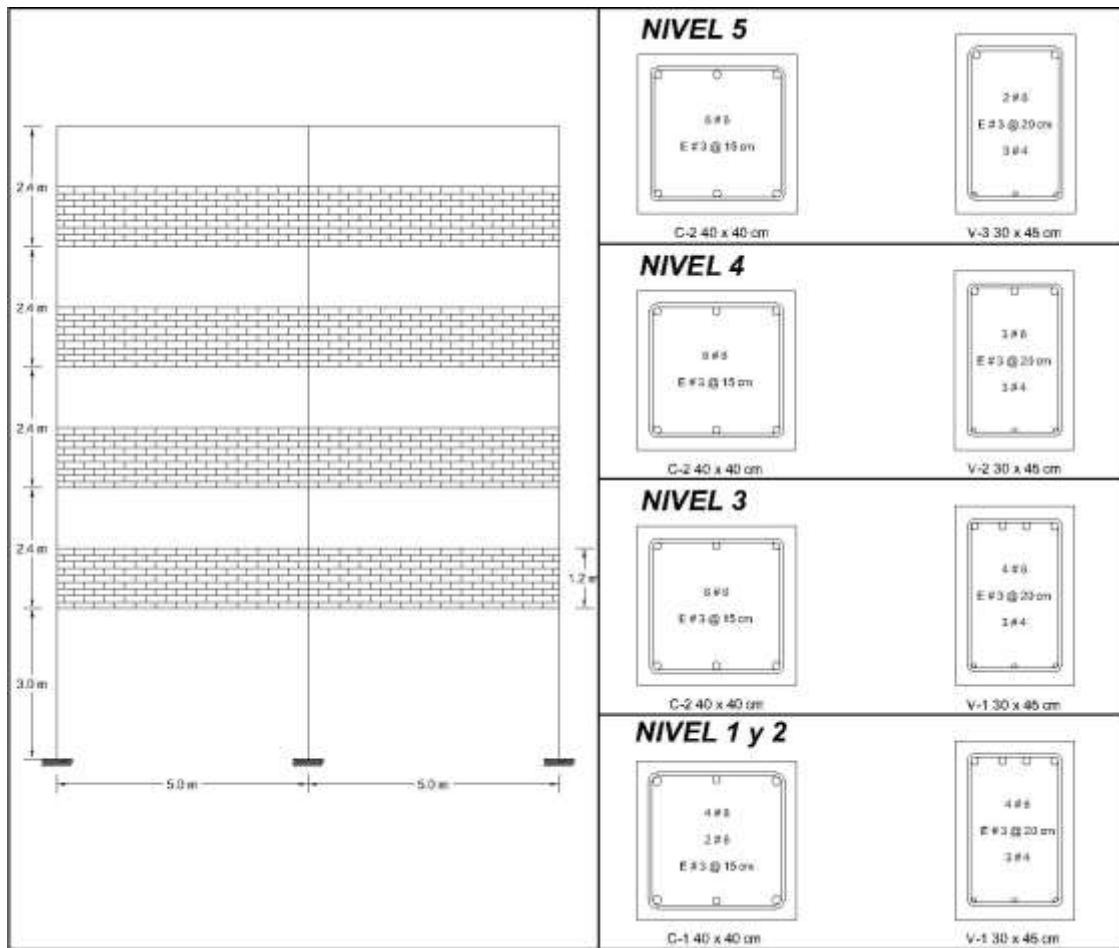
Armado de vigas y columnas para MCR de 5 con ML diseñadas con el RCDF-2004 (GDF, 2004a)
